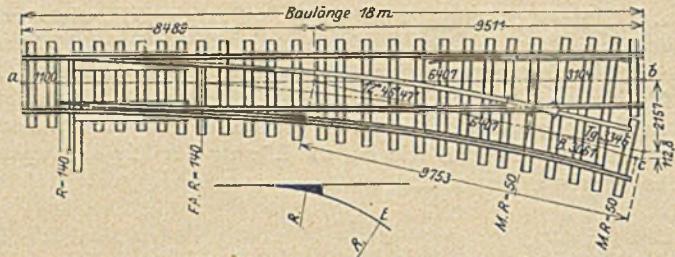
Zweizungenweiche mit Spurkranzauf lauf.
